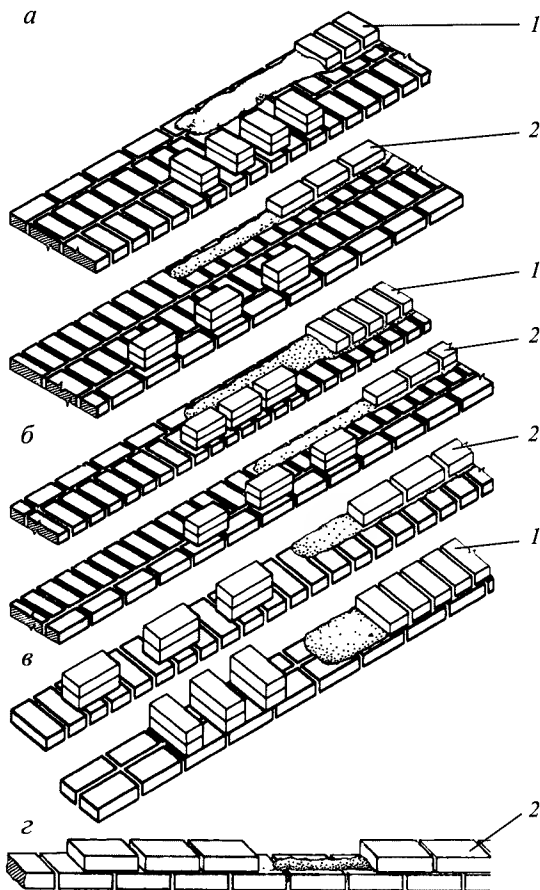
Раскладка кирпича при кладке стен и перегородок:
